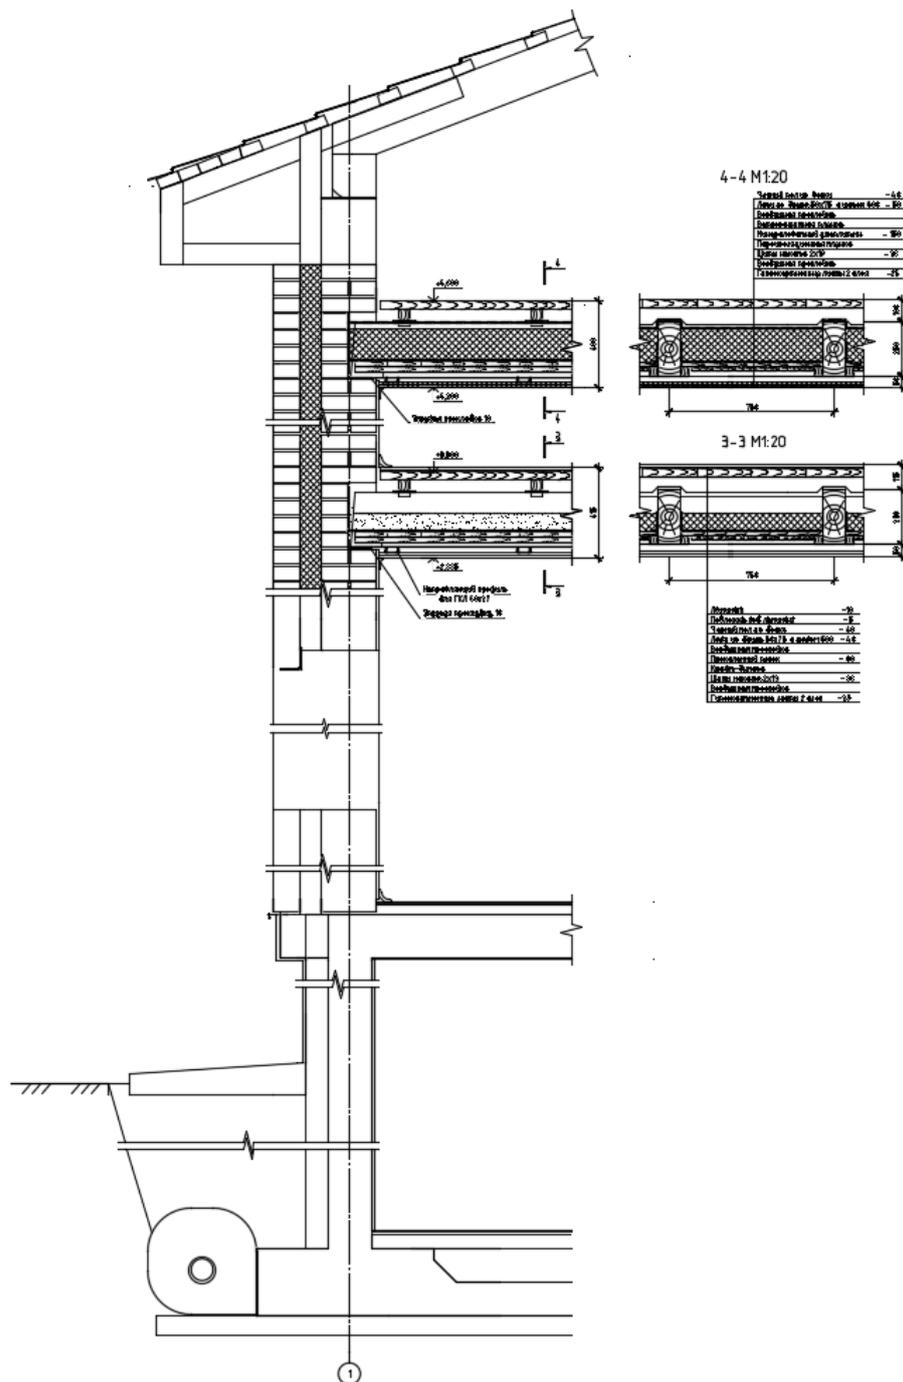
Схема разреза по наружной стене. На этапе разработки плана перекрытий необходимо разработать все конструктивные узлы перекрытий
